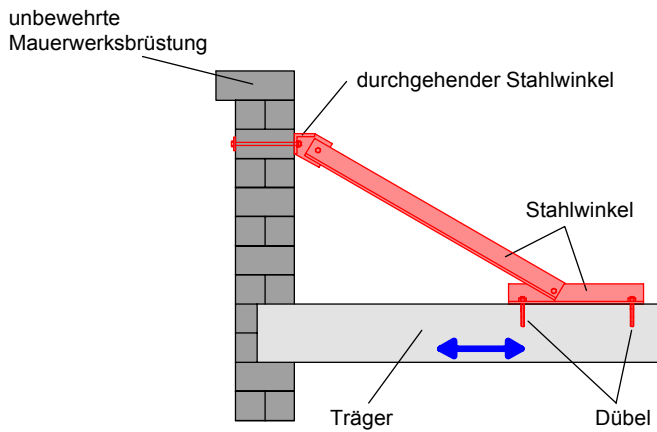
> Massnahmen für Brüstungen auf dem Dach
